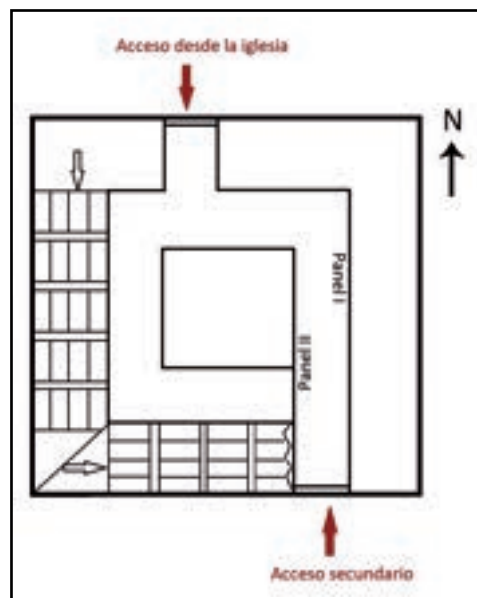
Croquis de la planta baja de la torre de Santa María (Autor: J. L. Sáez Iñiguez)
